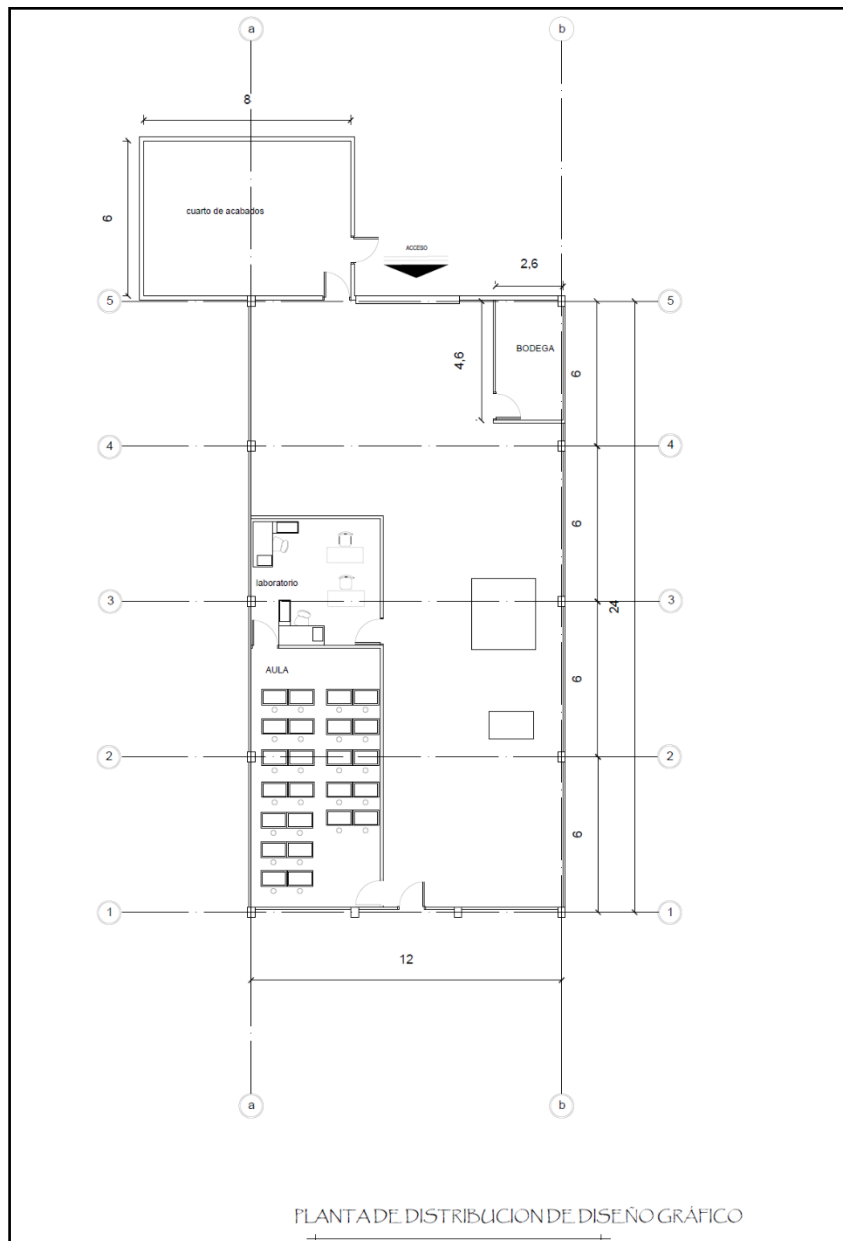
Plano Levantamiento planta física del taller de Diseño Gráfico
